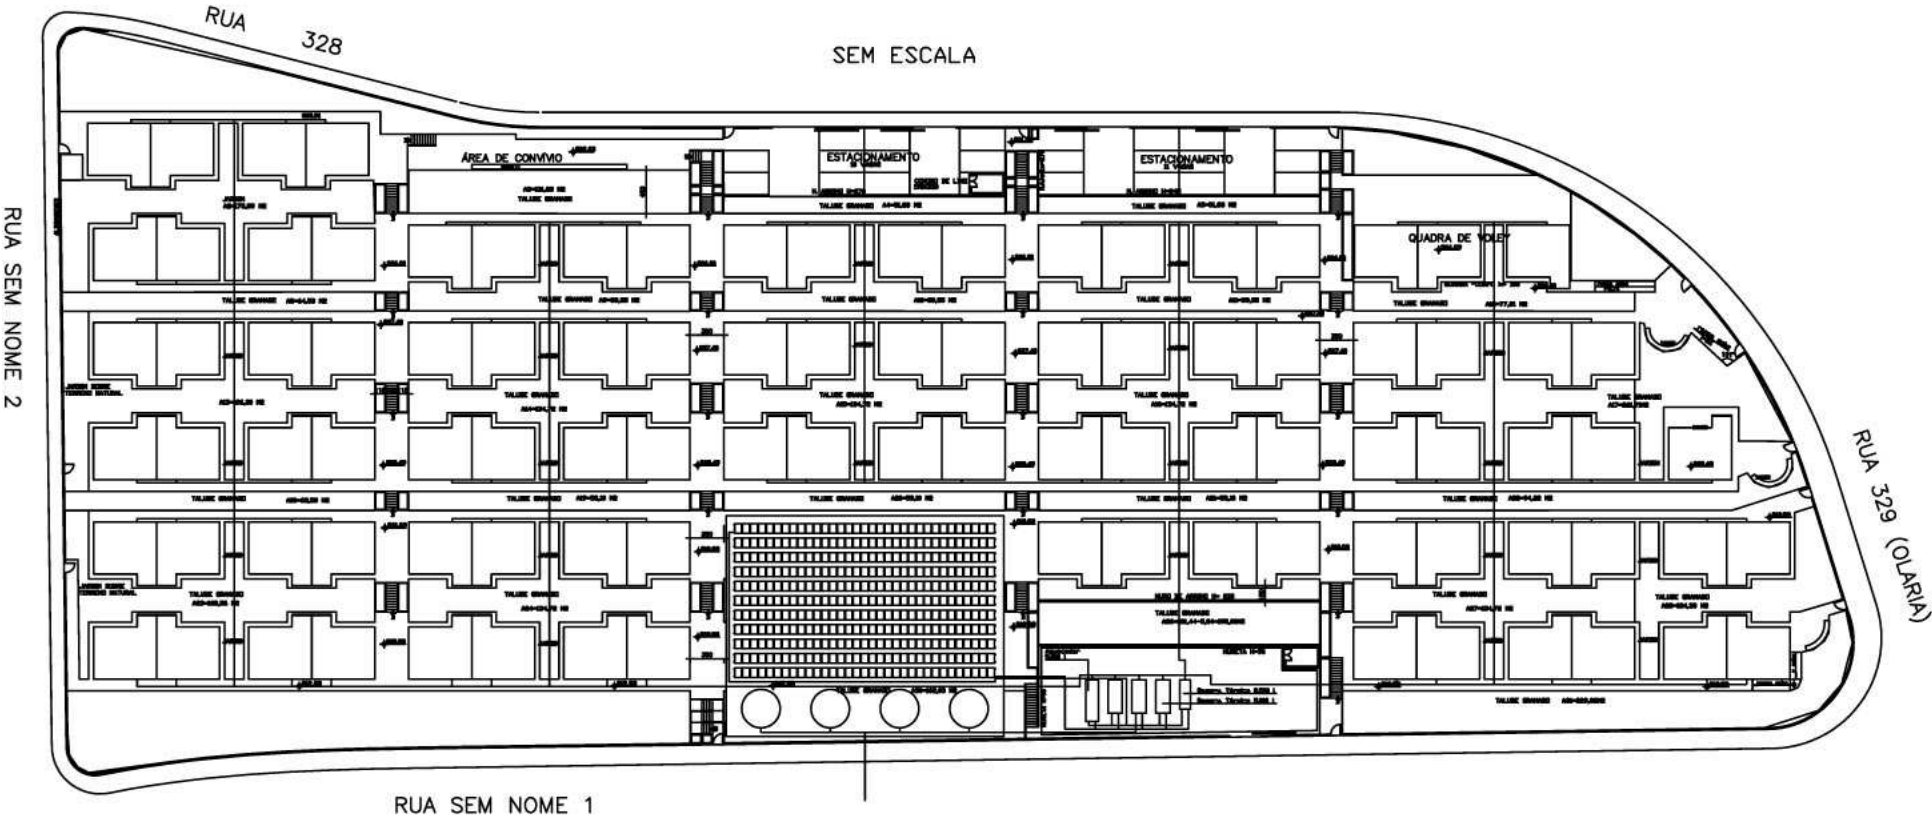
Planta indicativa da proposição de implantação do sistema de aquecimento distrital.
